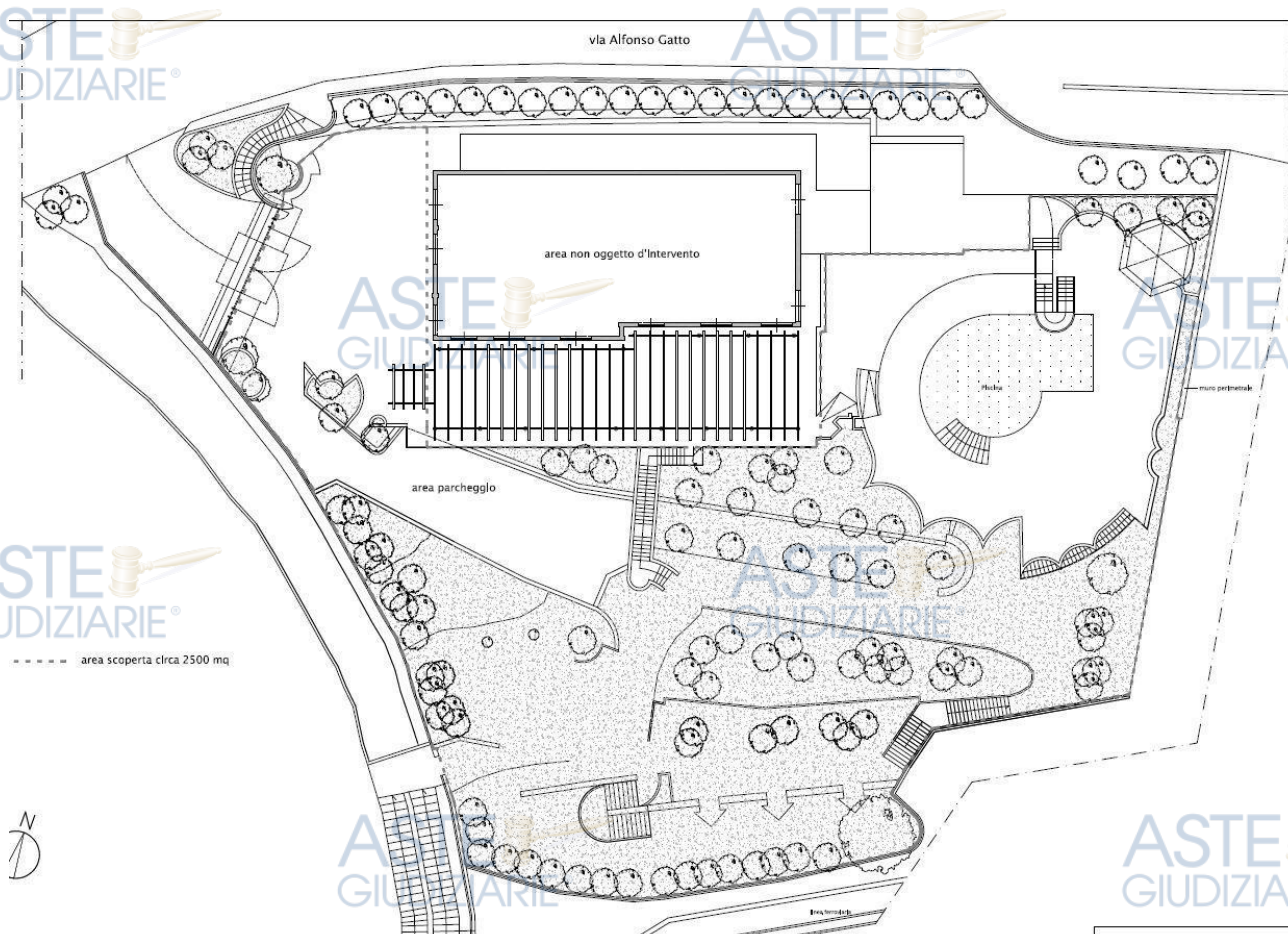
Planimetria generale della struttura estratta dalla pratica SCIA prot. 171557 del 04/10/2013
